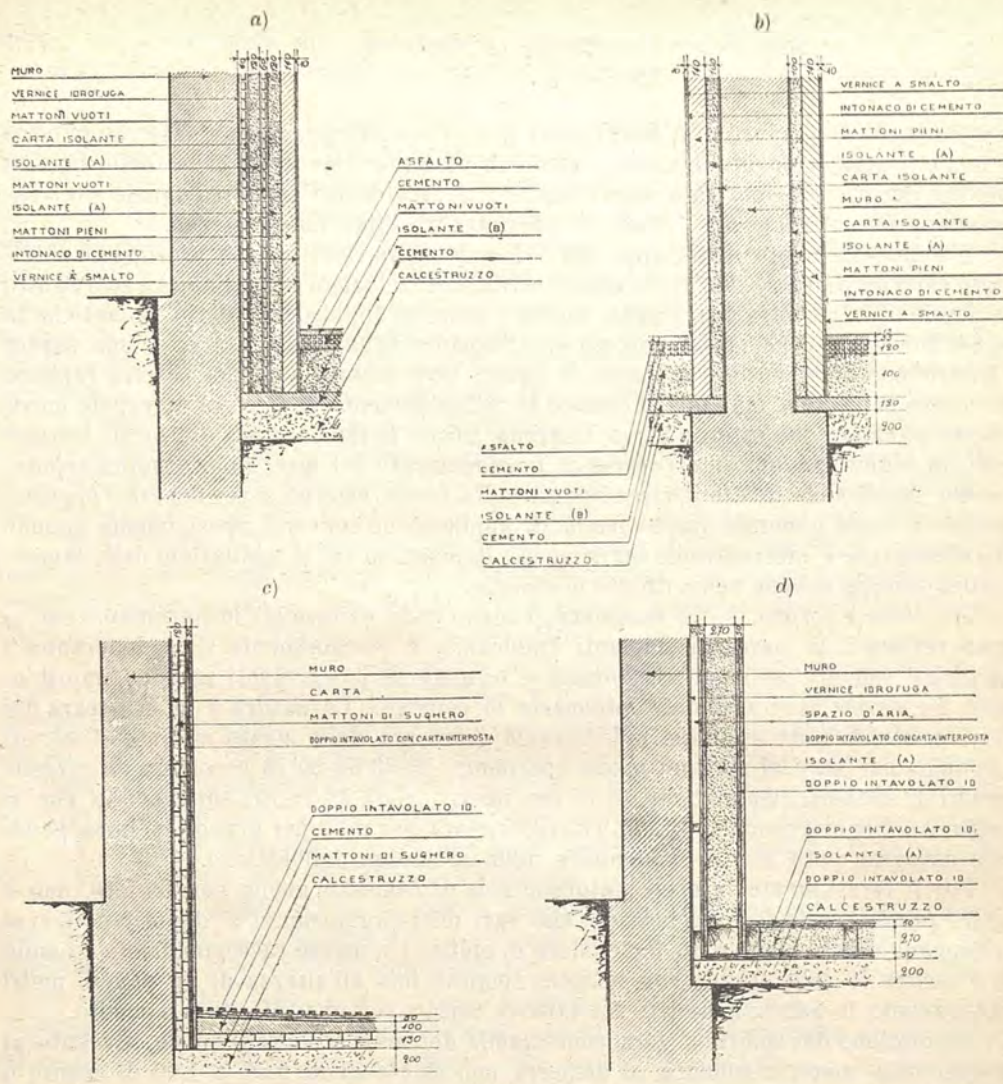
a, b, c, d. — Sistemi di isolamento di pavimenti e pareti.
